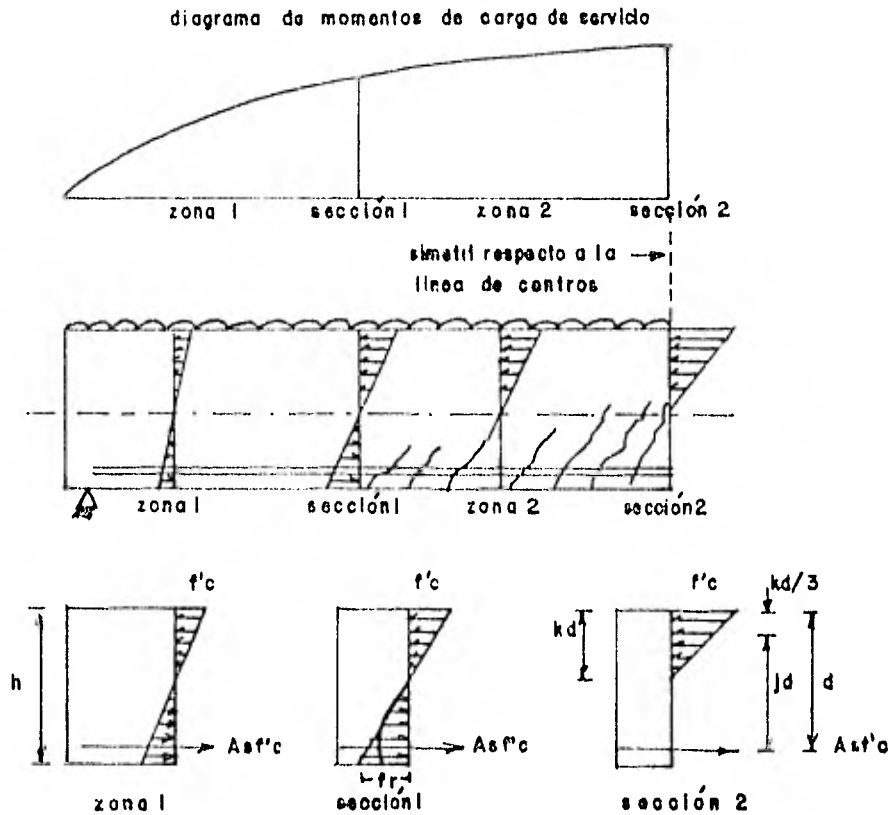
diversas zonas de esfuerzo y agrietamiento en una viga de concreto reforzado.
